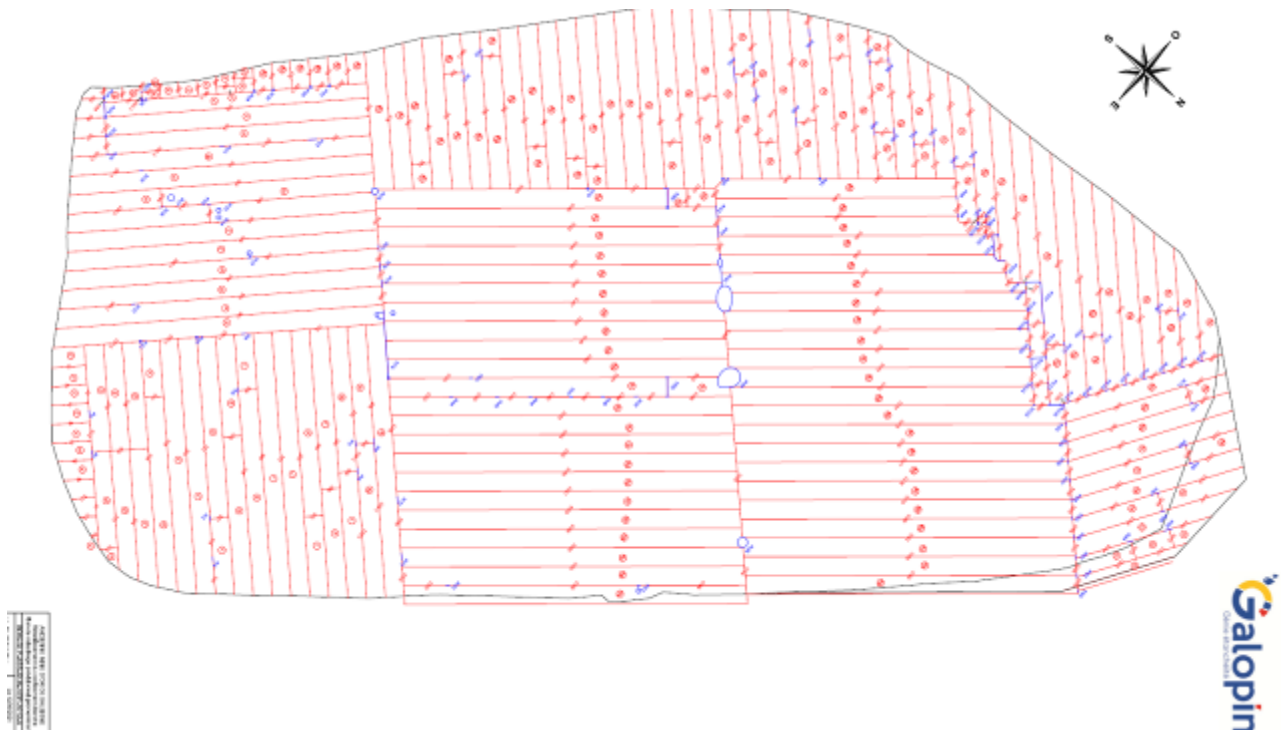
Plan de recollement de géomembrane de l'entreprise d'étanchéité
